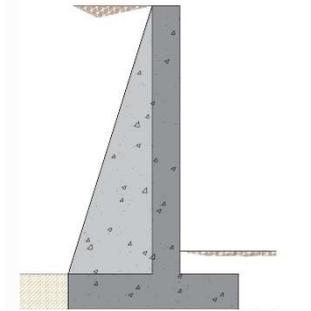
Muro con contrafuertes (Fuente propia, basado en [5])
